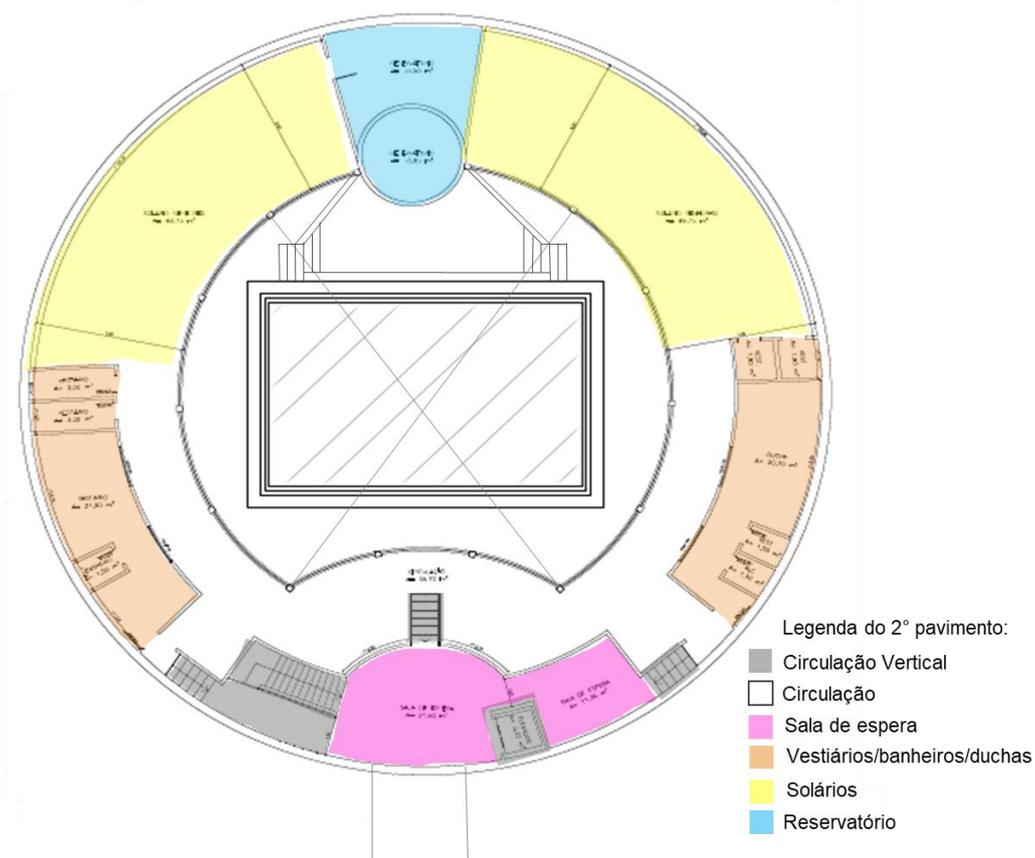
Esquema da planta baixa do 2º pavimento do Balneário Osvaldo Cruz. Adaptado de (ARQUIVO DA PREFEITURA DE IRAÍ, 2021).
